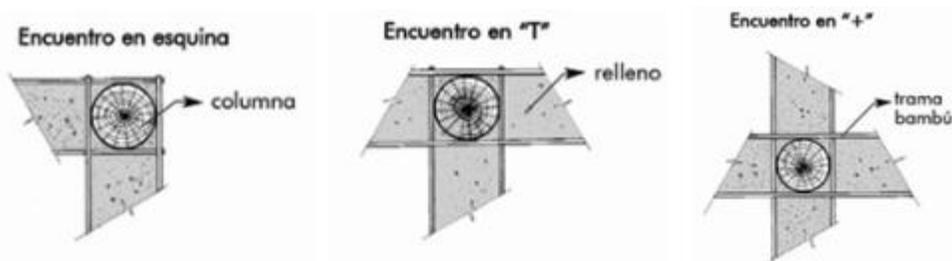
Detalle de la estructura de muro (Rivera, 2018)
